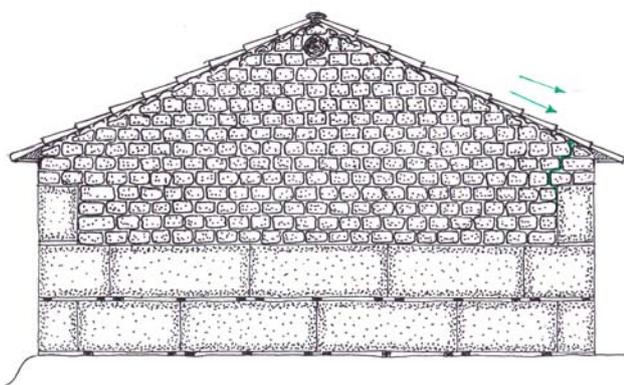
Fisuración por empuje de la cubierta de un edificio de adobe y tapia.
